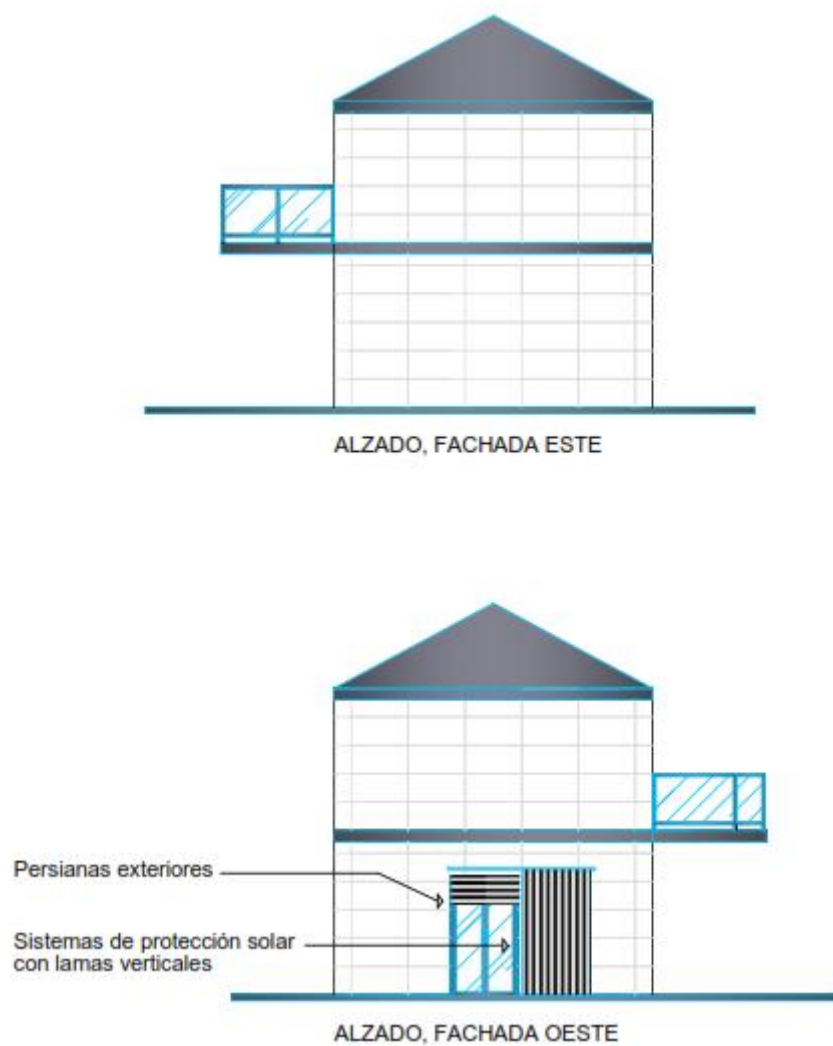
Persianas exteriores y sistemas de protección solar con lamas verticales en fachada oeste.
